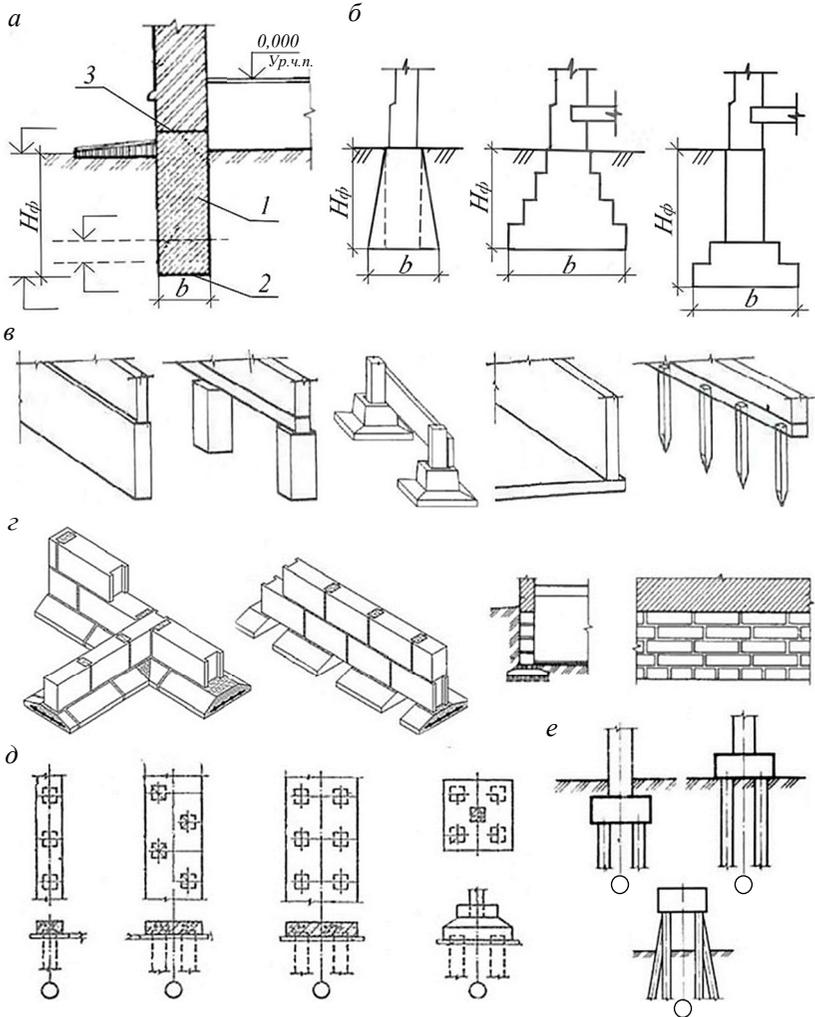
Фундаменты: *a* — элементы фундаментов: 1 — тело, 2 — подошва, 3 — обрез, H_{ϕ} — глубина заложения, b — ширина подошвы; *a* — *б* — поперечные профили: прямоугольный, трапециевидный, ступенчатый, с подушкой; *в* — конструктивные схемы: ленточные, столбчатые (под стеной), сплошные (плита), свайные; *г* — ленточные сборные из плит и блоков: сплошные, прерывистые, разрез, фрагмент раскладки (развертки); *д* — свайные: расположение рядами, кустом; *е* — виды свайных ростверков: низкий, высокий
